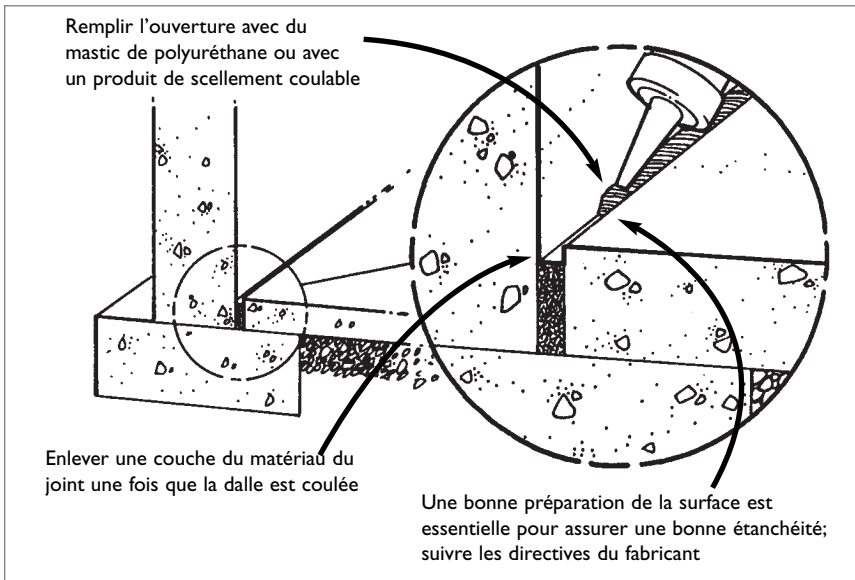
Obturer la jonction entre le mur de fondation et le plancher du sous-sol dans les constructions neuves
